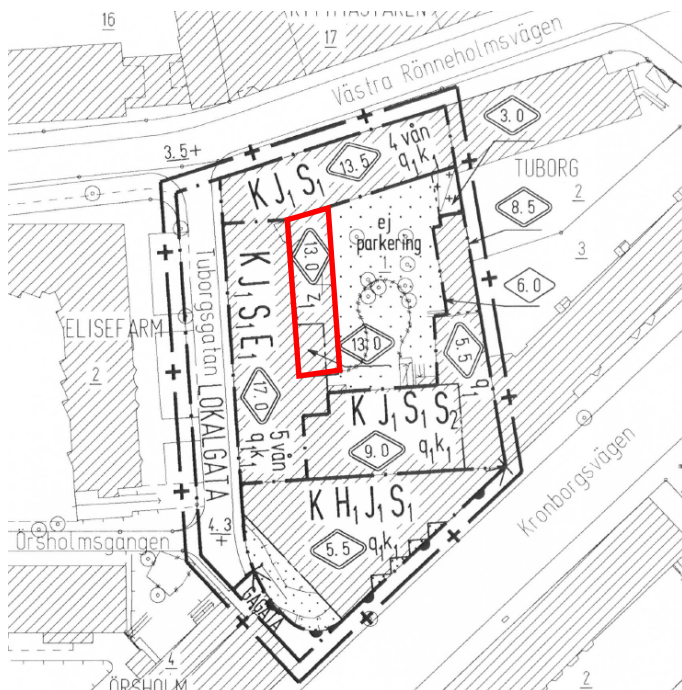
Planändringen möjliggör att yta under befintlig vitputsad byggnad, på innergården, kan byggas in.
